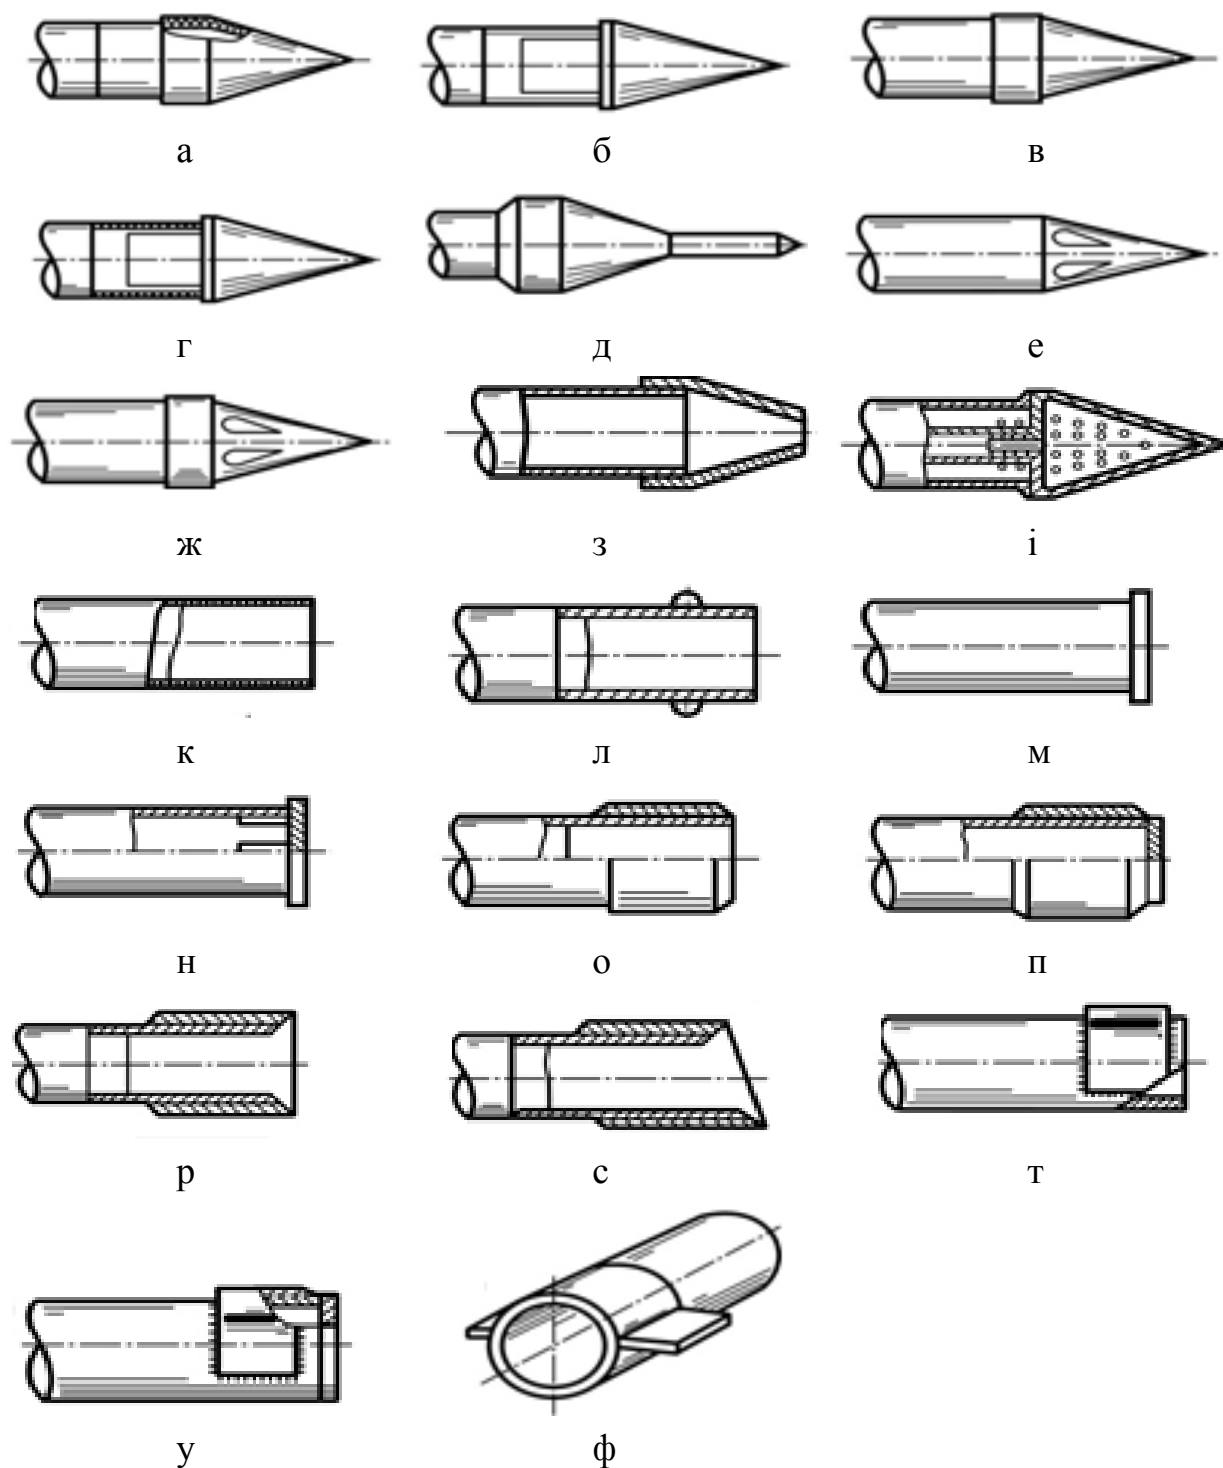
Наконечники для безтраншейного прокладання труб способом проколювання і протискування: а, б, в – конусні; г – конусний з ексцентриситетом; д – конусний зі штирьом; е, ж – конусний зі щілинними прорізами; з – конусний зі зрізаною вершиною; і – конусний з отворами для зволоження ґрунту; к – з відкритим кінцем труби; л – з відкритим кінцем труби і кільцем; м – з привареною заглушкою; н – із знімною заглушкою; о – кільцевий ніж із зовнішнім загостренням крайок; п – те ж, із привареною заглушкою; р – кільцевий ніж із внутрішнім загостренням крайок; с – кільцевий ніж клиноподібної форми з внутрішнім загостренням крайок
